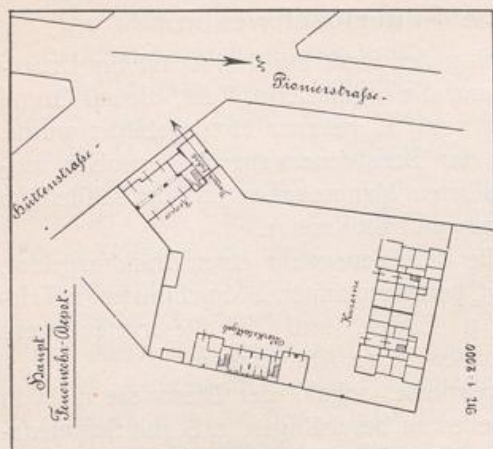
Lageplan des Feuerwehrdepots an der Hüttenstrasse.
